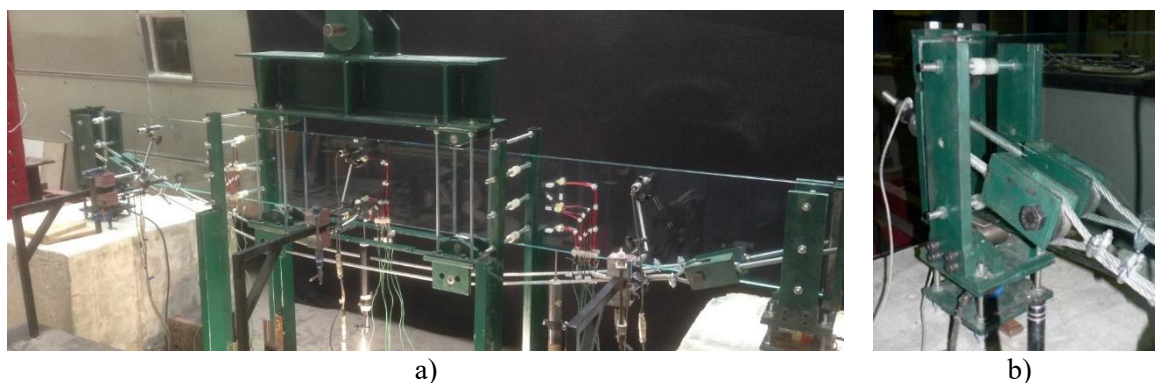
Sistema de ensaio com pré-esforço: a) vista global; b) pormenor de ancoragem
